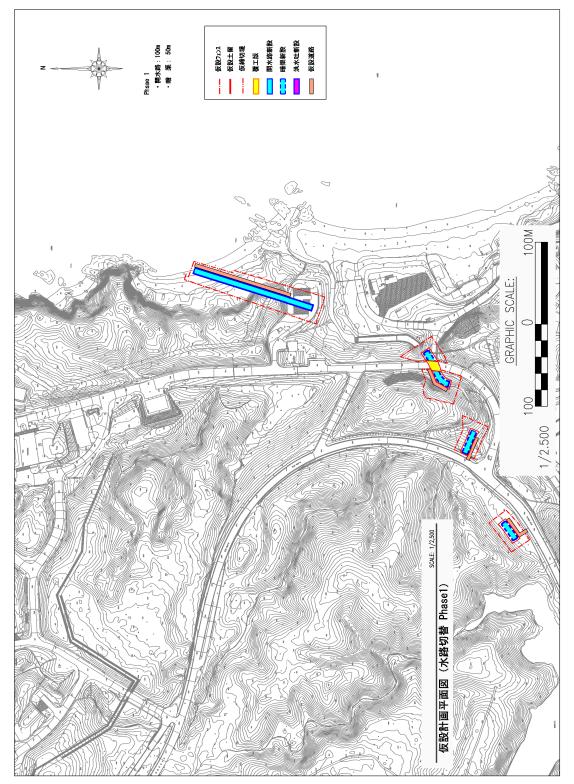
(1) 美謝川の切替え仮設計画平面図 (Phase1)
